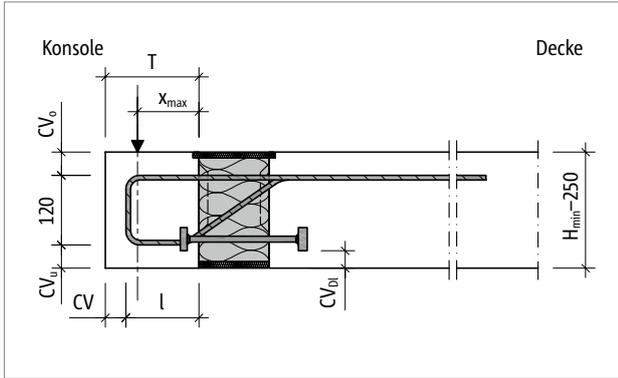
Schöck Isokorb® XT Typ O: Produktschnitt
